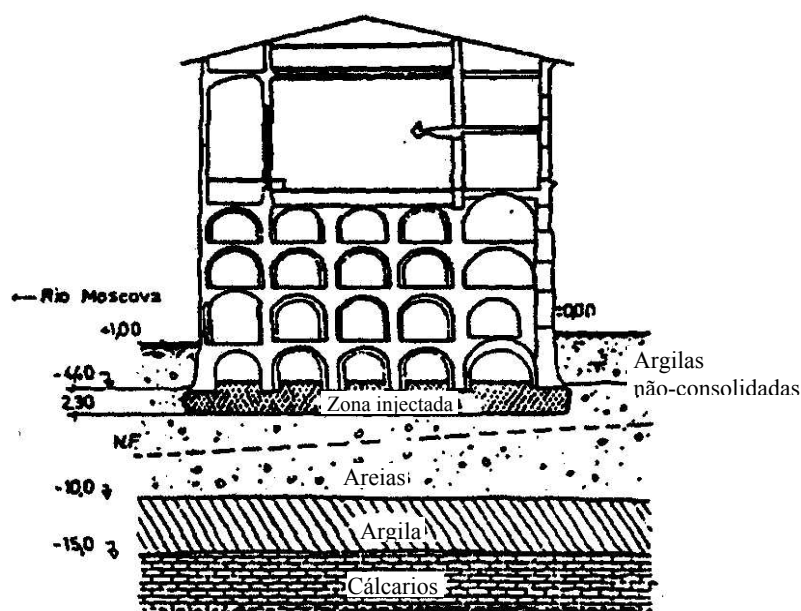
“Laje” de recalço instalada sob as fundações existentes por injeção do solo [Rodríguez Ortiz, 2002].
